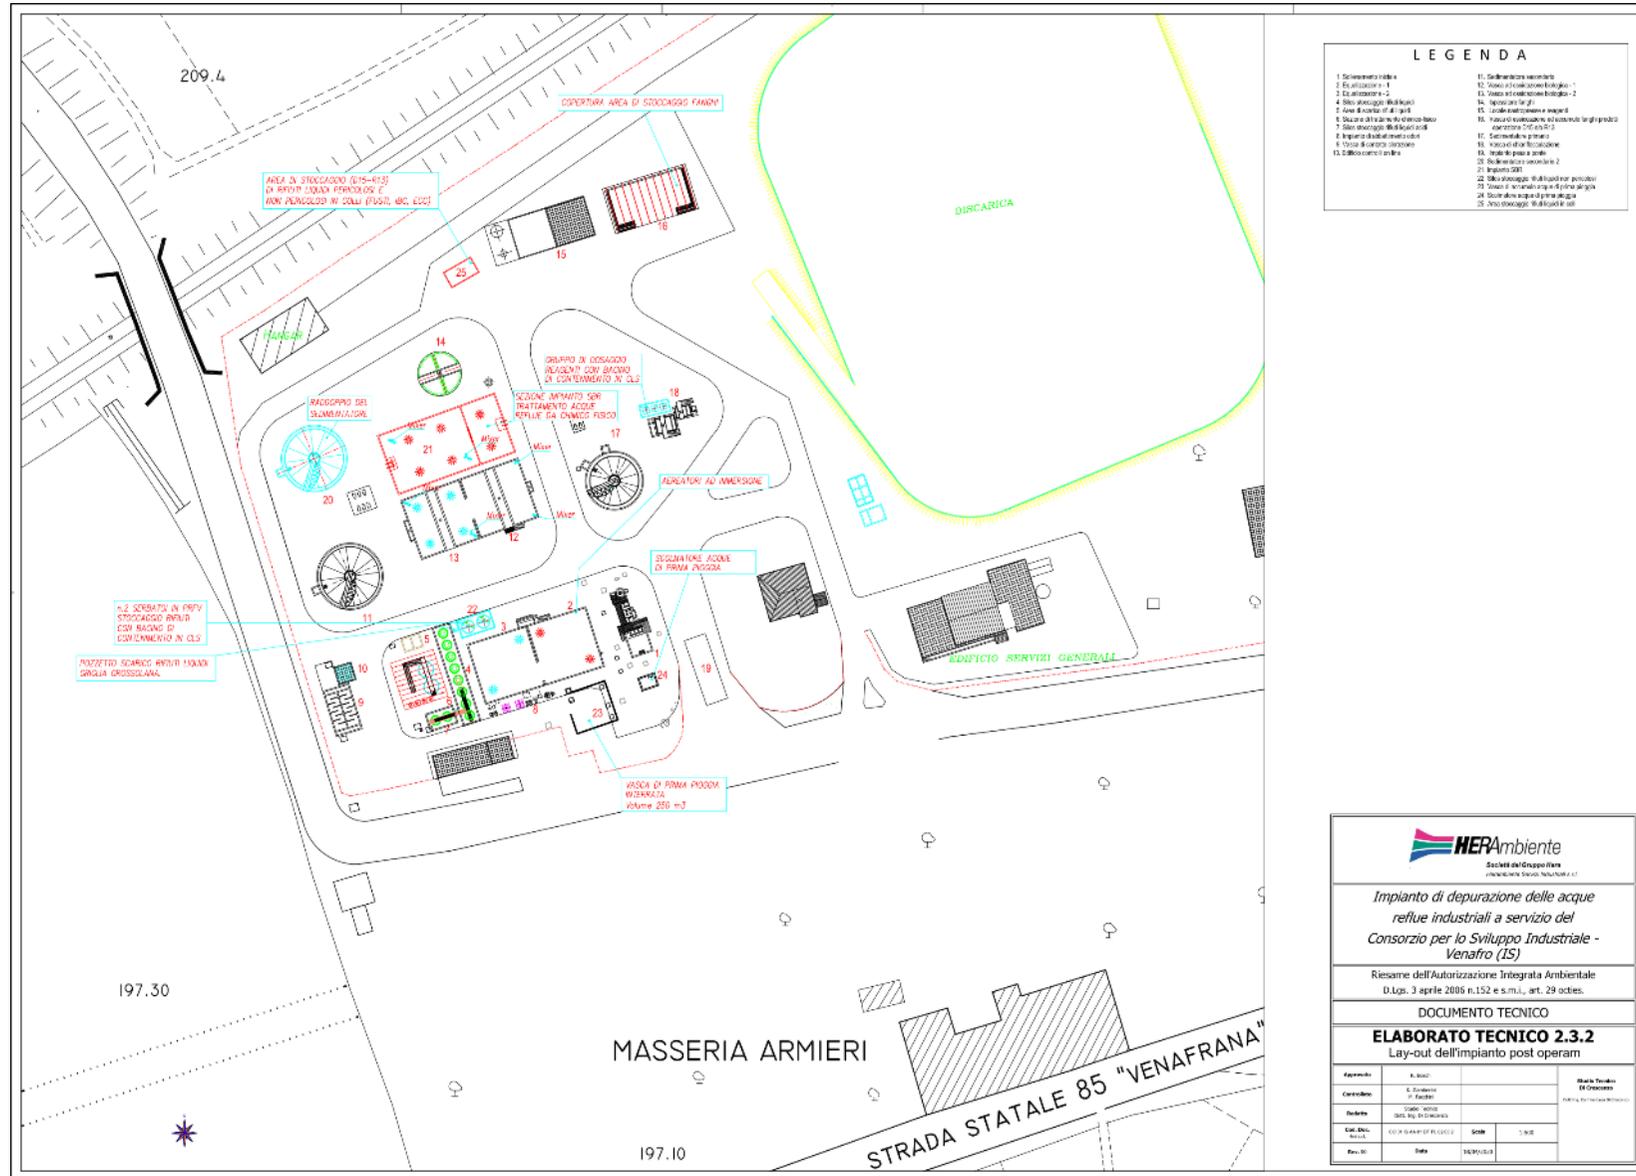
planimetria generale dell’installazione: assetto “post operam”
